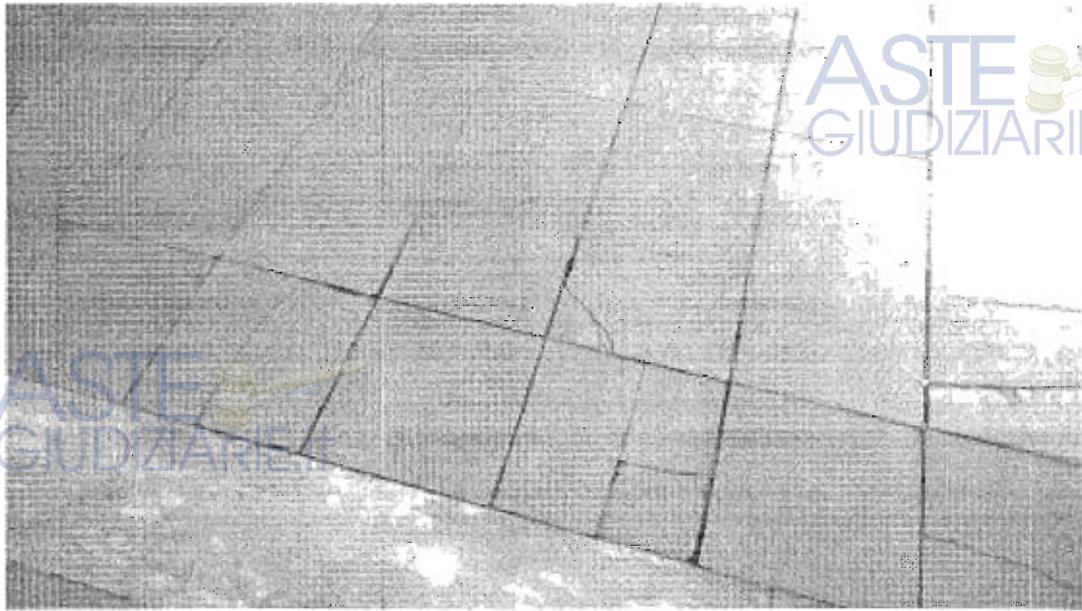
(Piano Secondo, vista pavimentazione Promenade)
